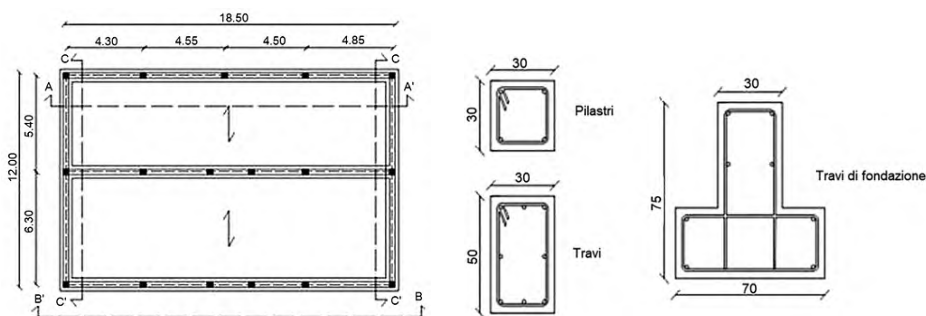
Pianta fondazioni, sezioni pilastri, travi e travi di fondazione
